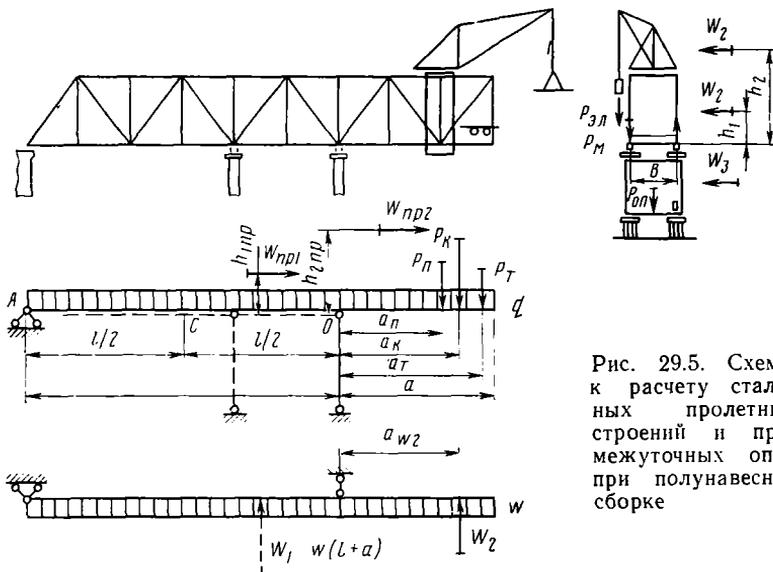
Схемы к расчету стальных пролетных строений и промежуточных опор при полунавесной сборке
